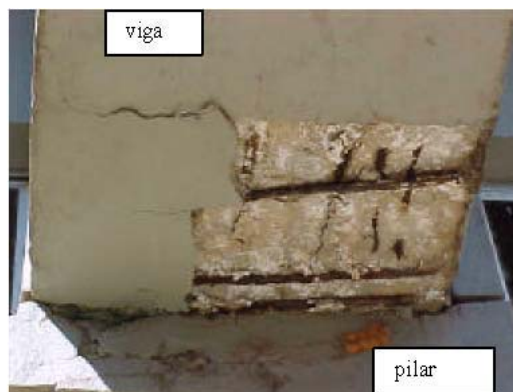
sinais de esmagamento no concreto do pilar (Fi=3) e corrosão na viga (Fi=4)
